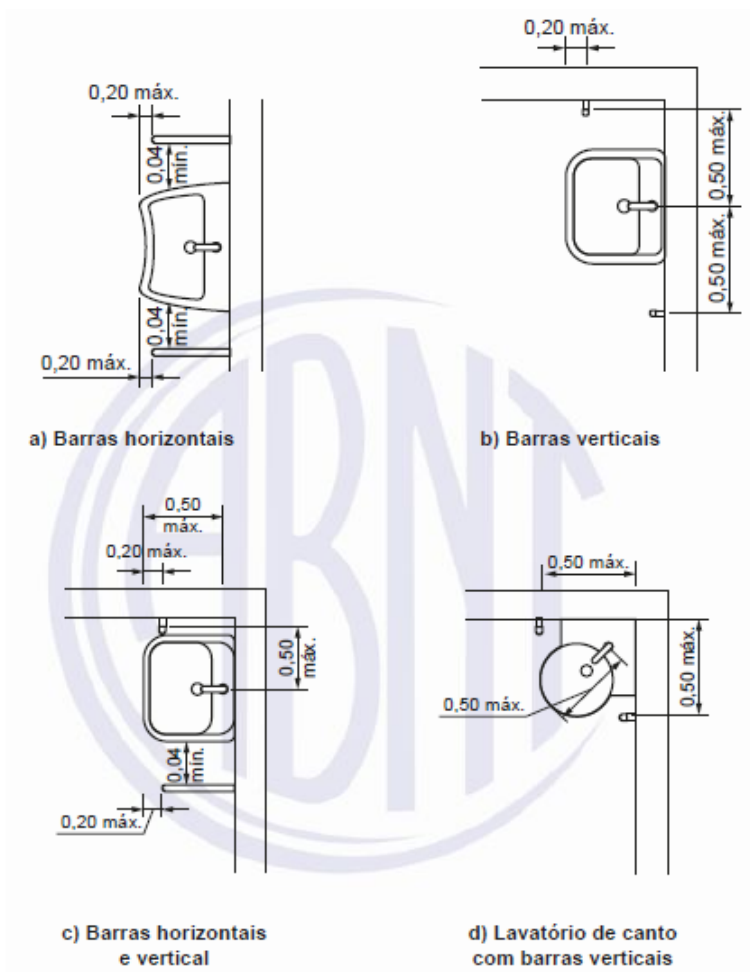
Modelos de opções de instalação de lavatórios e barras de apoio - Planta baixa (Obs: Medidas em metros) Fonte: NBR9050/2020
